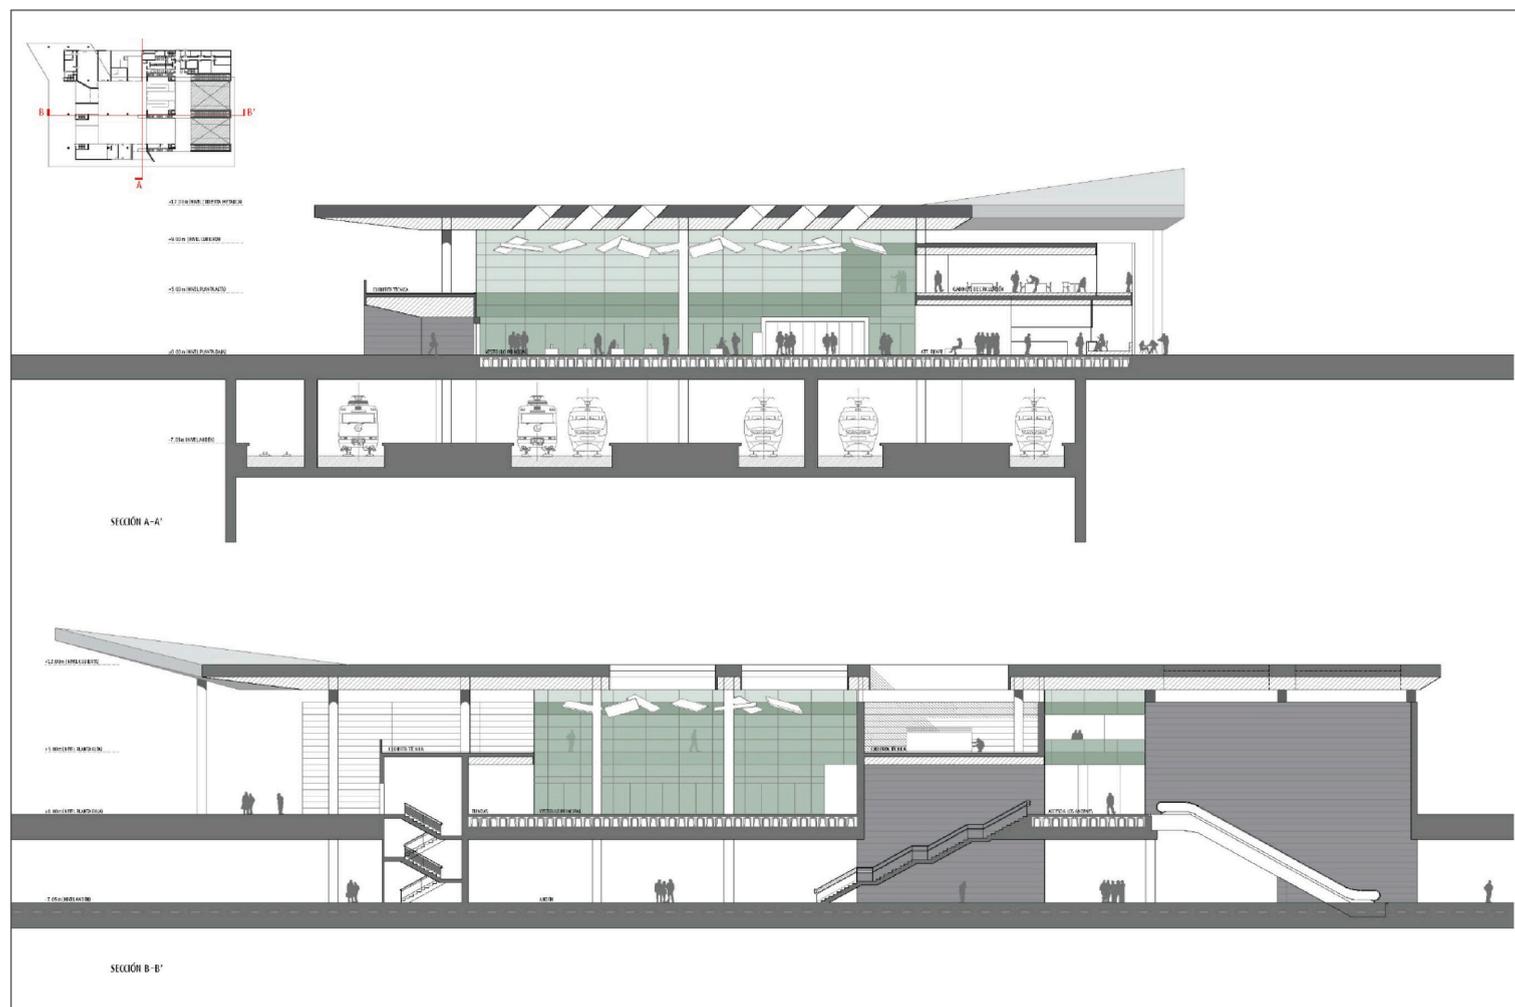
Sección tipo de la estación. (Fuente: Proyectos de construcción RAF Murcia. Soterramiento de Estación y Barriomar y Nonduermas”, noviembre 2018, ADIF)
